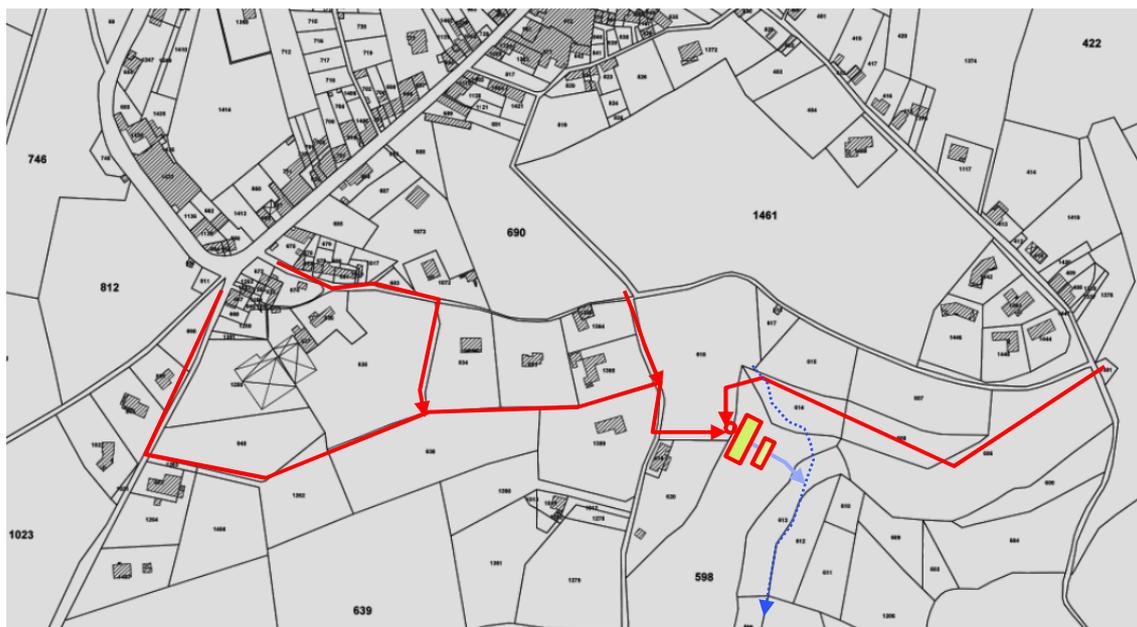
Plan de situation des travaux solution filtre planté de roseaux
